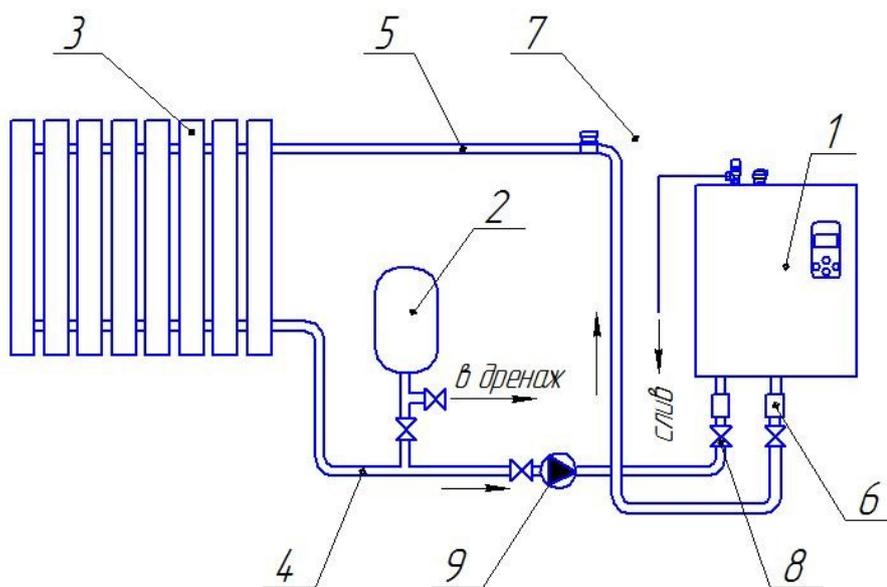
Упрощенная схема использования ЭВН-К в системе отопления (Вариант 2)
